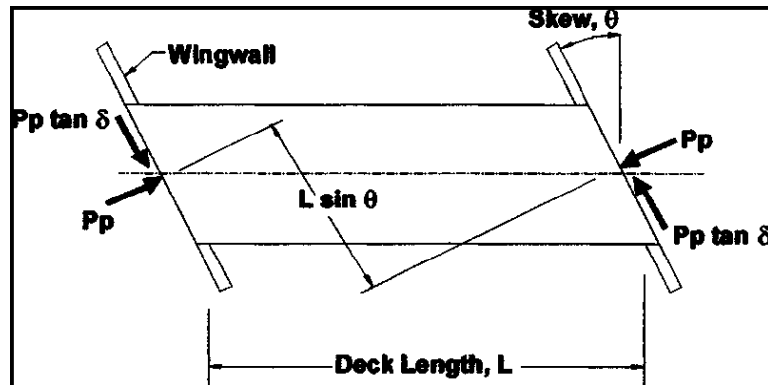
Effetto dell'obliquità in pianta dell'impalcato
